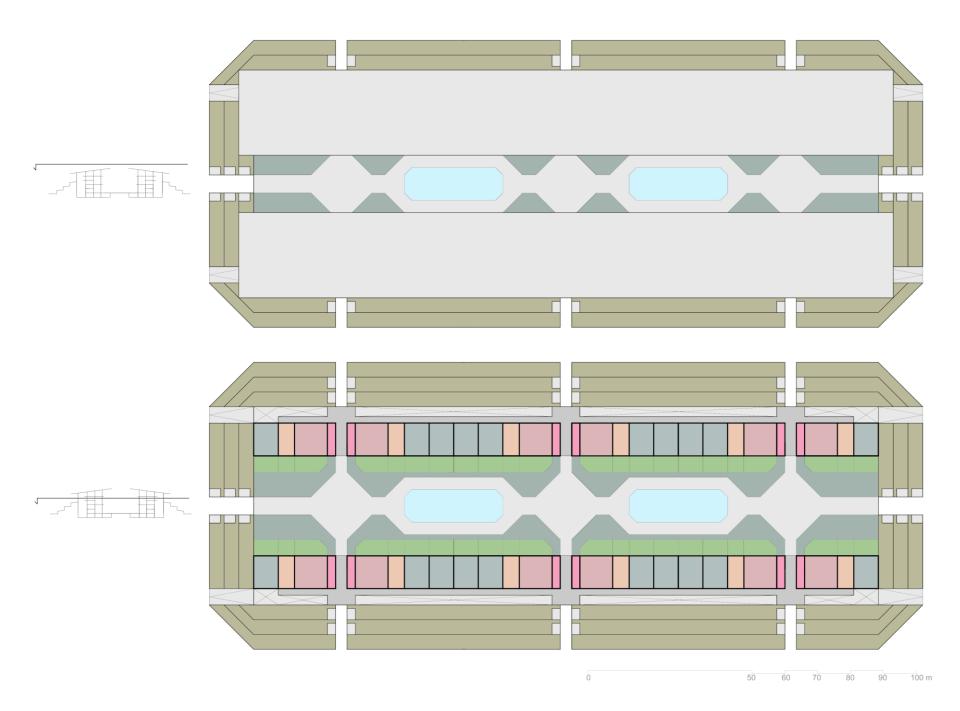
planta de cubiertas (arriba) y planta desde la tercera planta (abajo)
